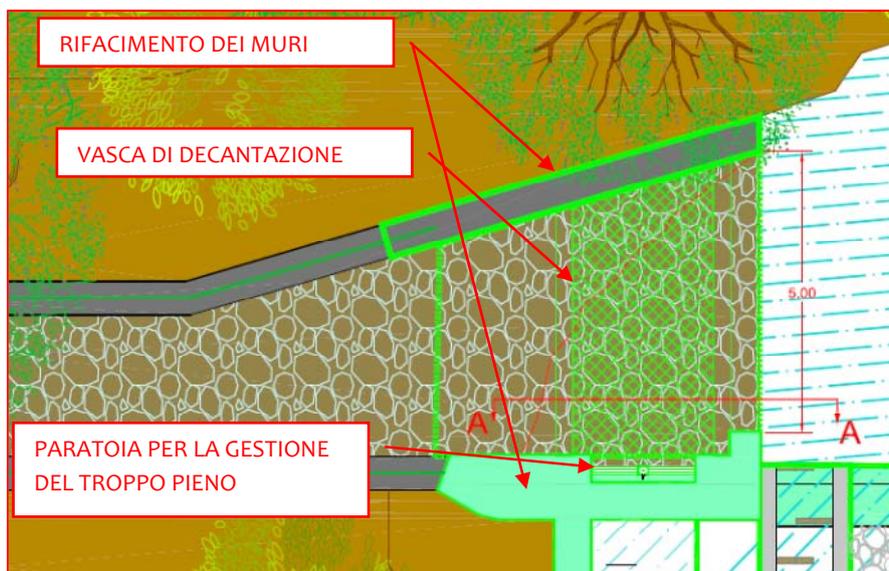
a Canale di derivazione - Pianta dell'imbocco (In verde tratteggiato la zona di intervento)
